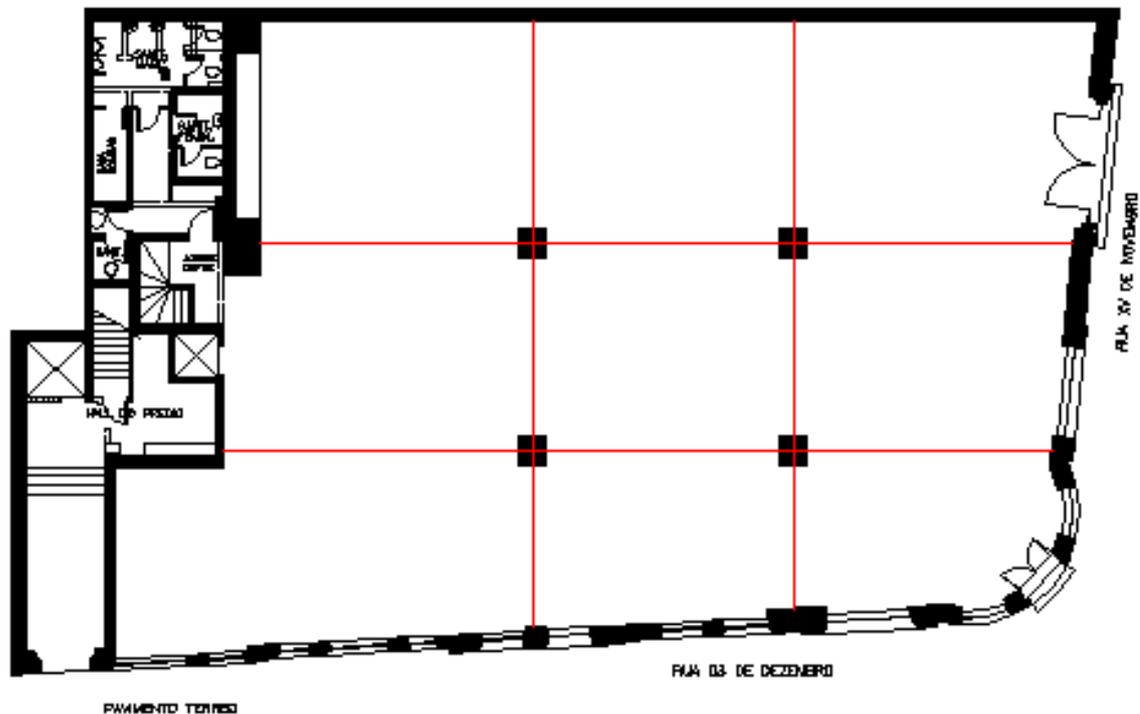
Planta pavimento térreo. Rua XV de Novembro, 268
